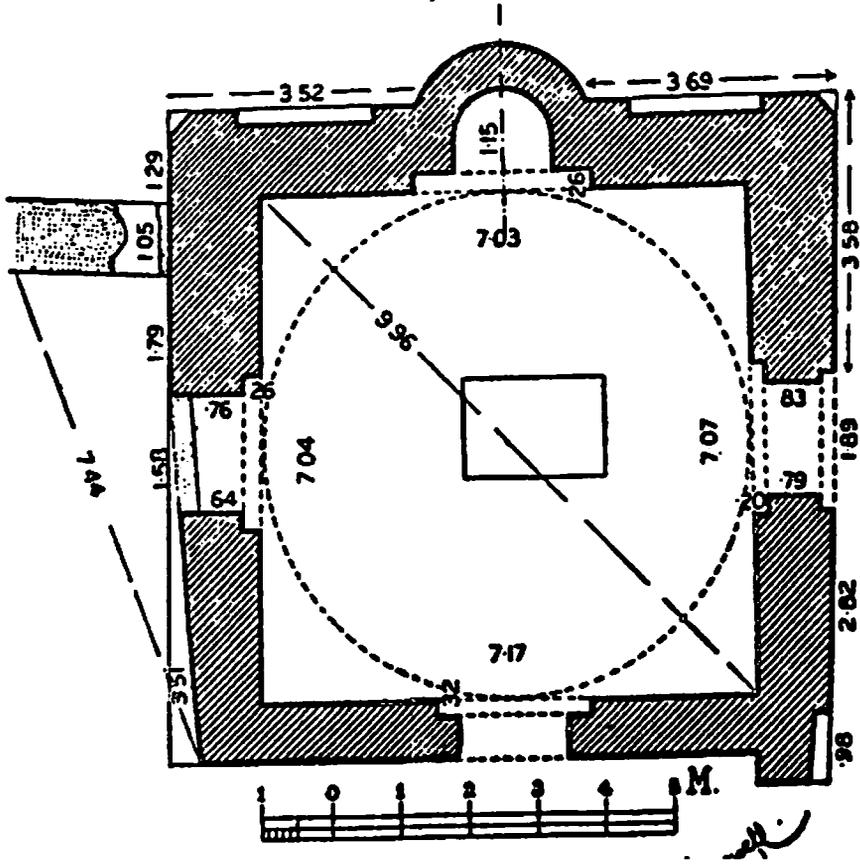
مسقط أفقى لقبه الإمام الشافعى . عن :
